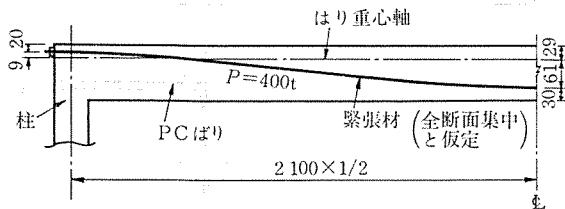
PCばかり緊張材の配置ー屋階ばかりの場合(単位:cm)
